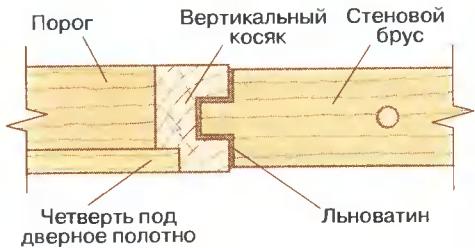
Пример установки дверного косяка в брусовом срубе (вид сверху)
